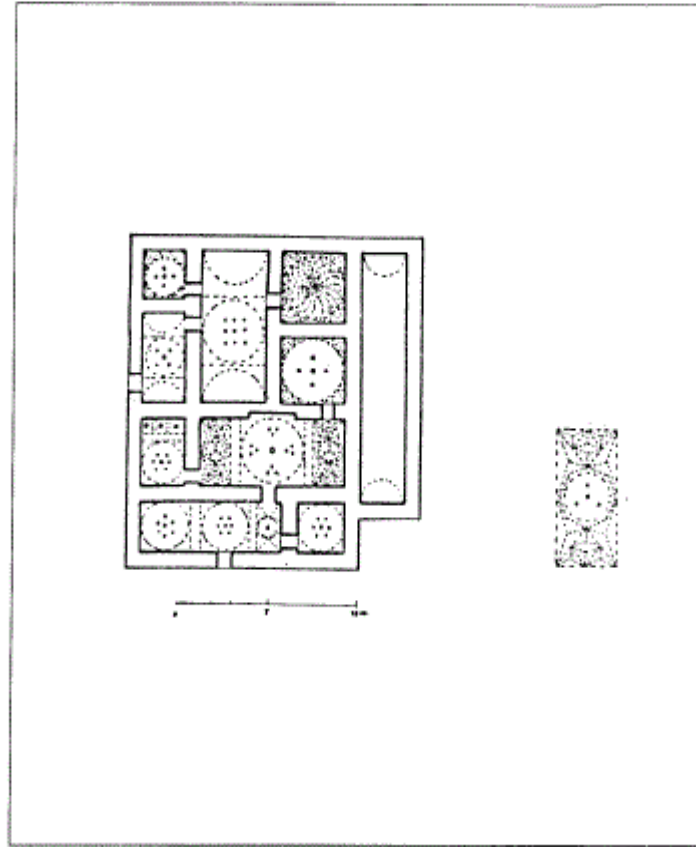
مسقط أفقي لحمام سنان بك في Karnabat (عن : كيل) .
